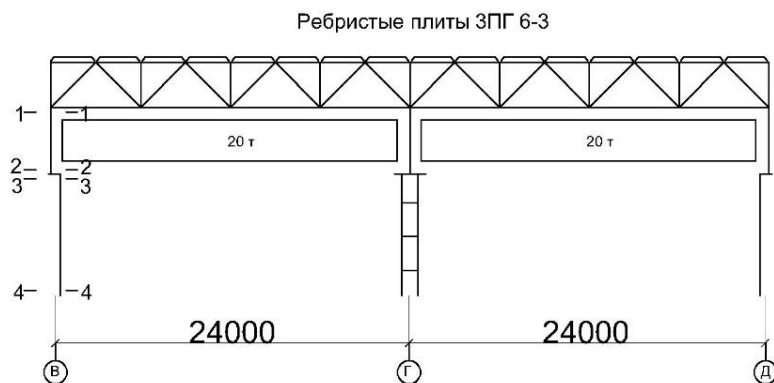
Расчетная схема рамы с покрытием из железобетонных плит
